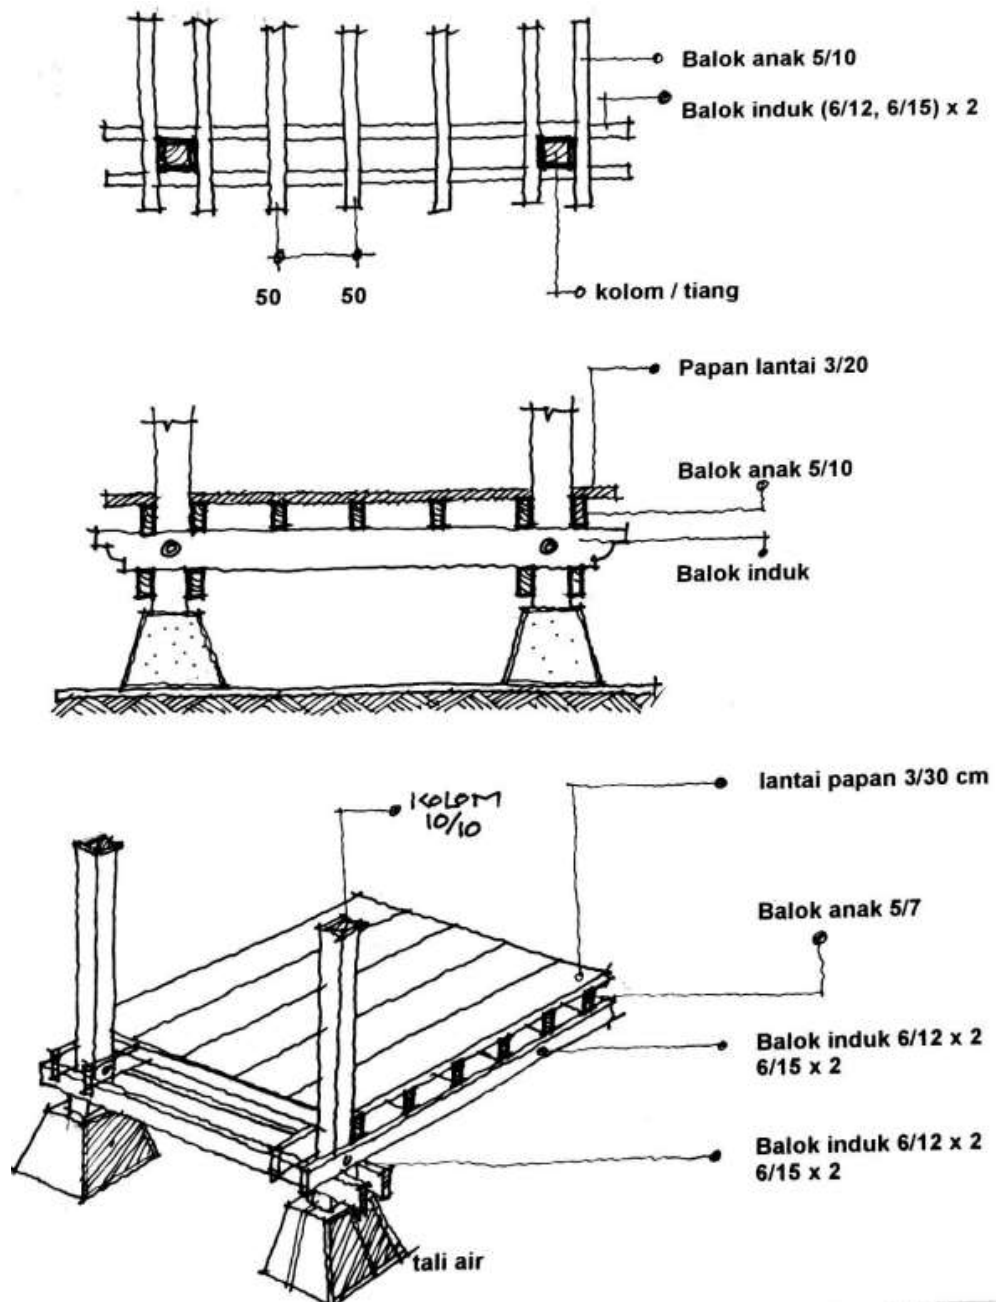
Skets hubungan plat lantai dengan balok (Sumber sketsa penulis)
